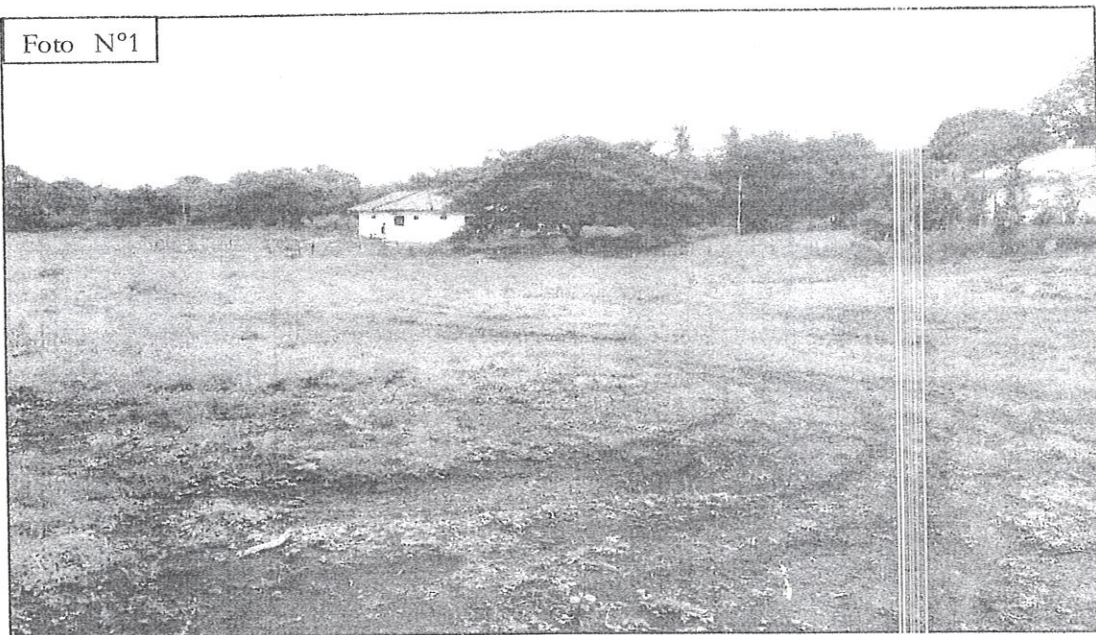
Vista general del terreno. Se observa la topografía y la vegetación.
